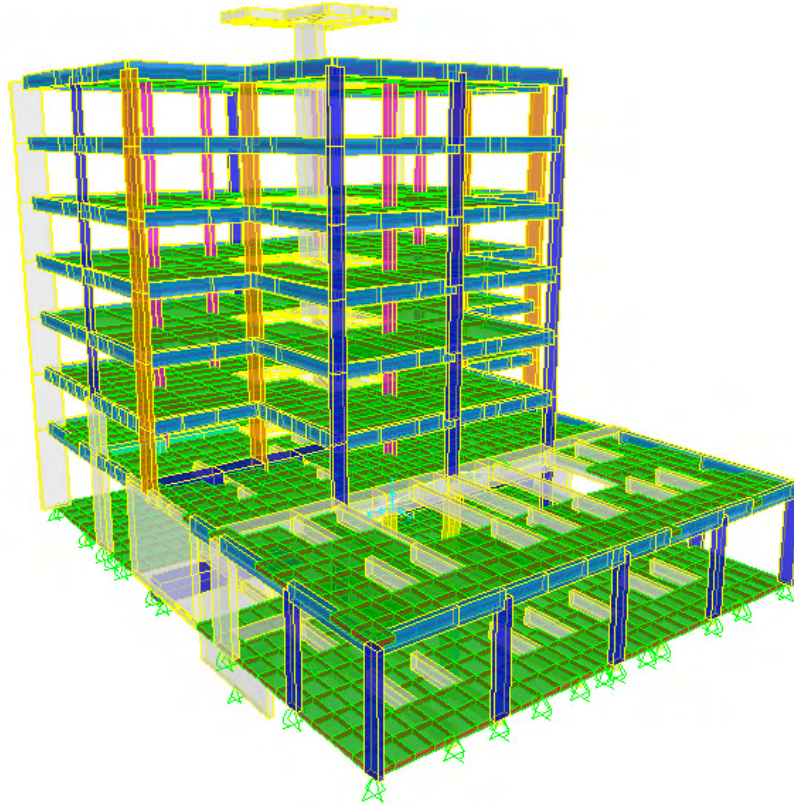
Modelo Global – Vista da fachada de tardoz
